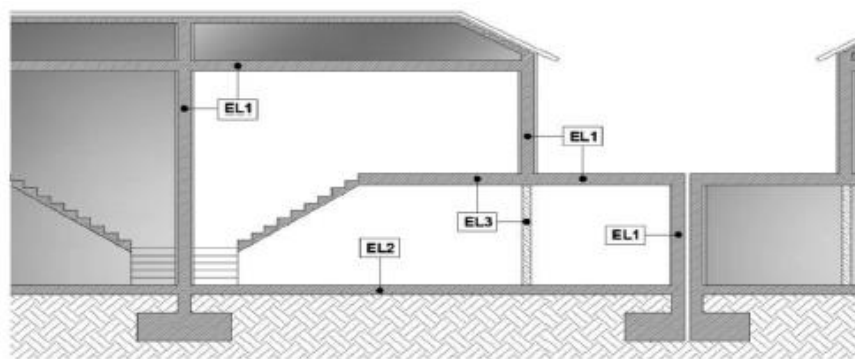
Identificação dos elementos construtivos para o cálculo da inércia térmica interior ([21])
